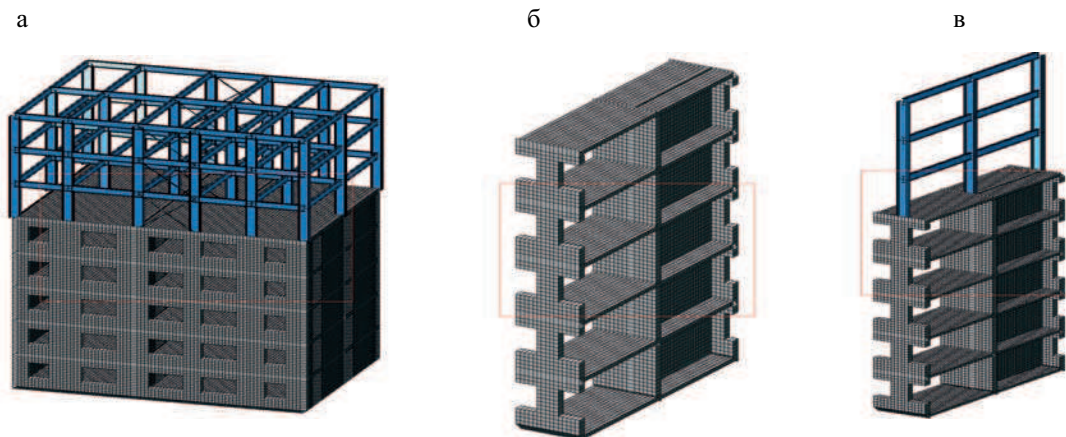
Расчетные схемы реконструируемого здания: а - пространственная расчетная модель здания; б - исследуемый фрагмент реконструируемого здания; в - исследуемый фрагмент здания с надстройкой
